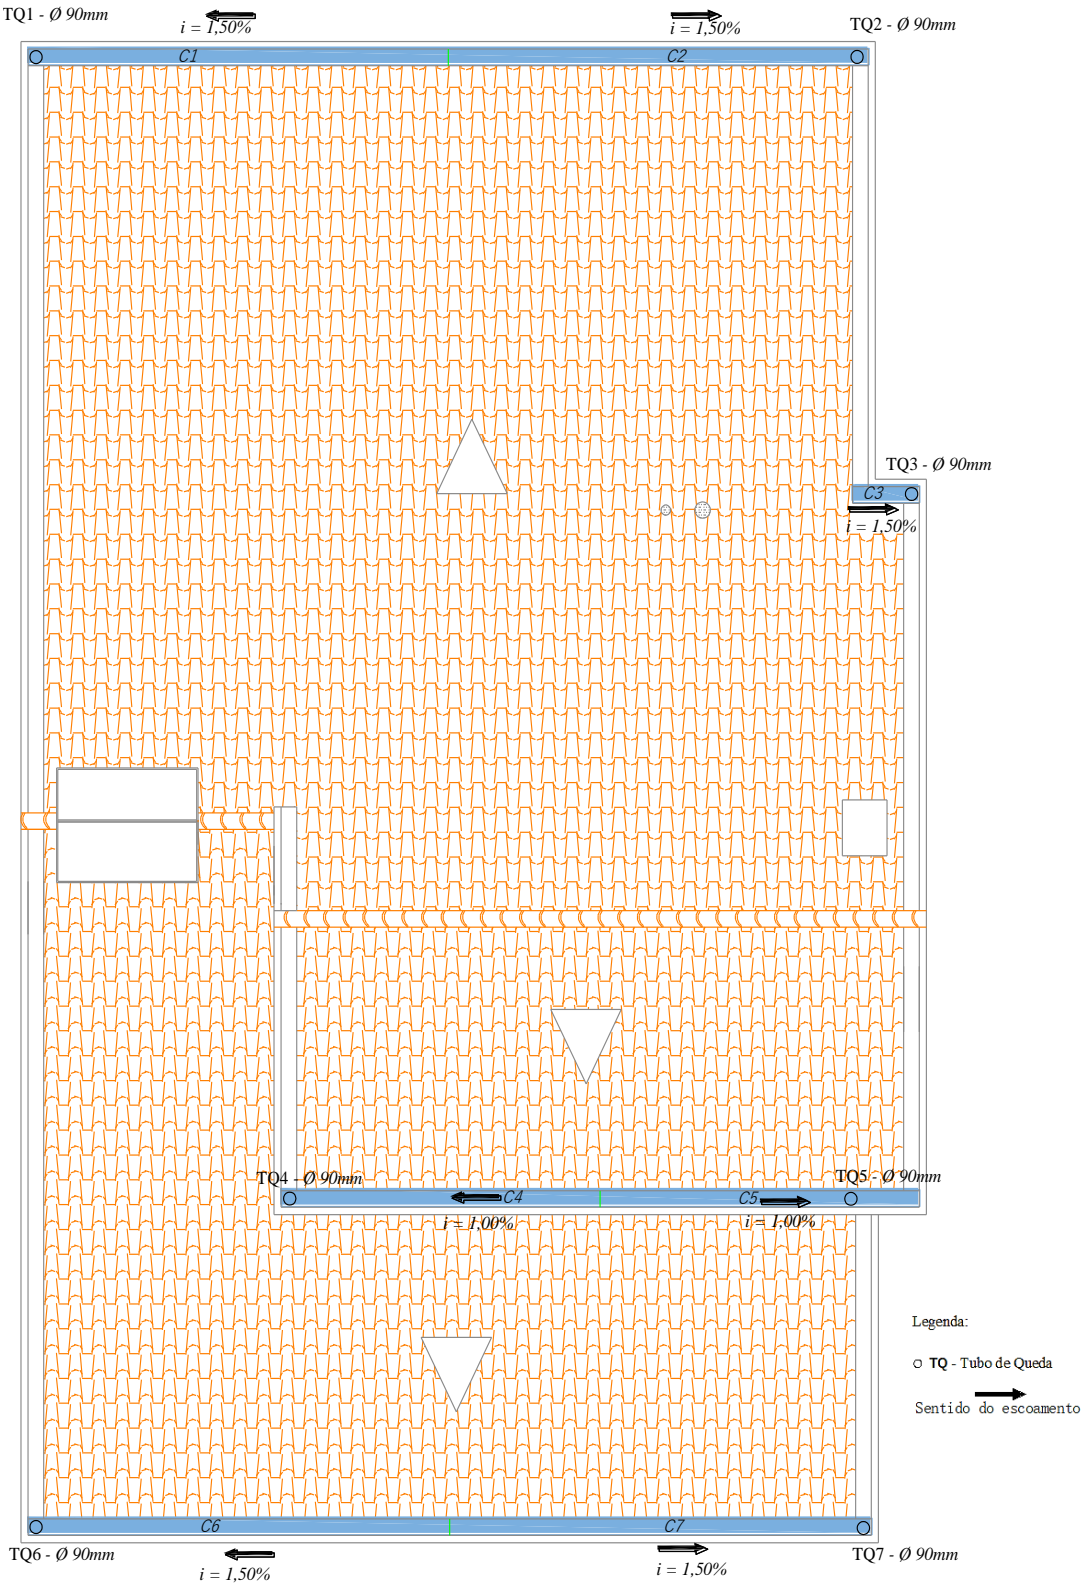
Rede predial de drenagem de águas pluviais, planta de cobertura, sem escala.
